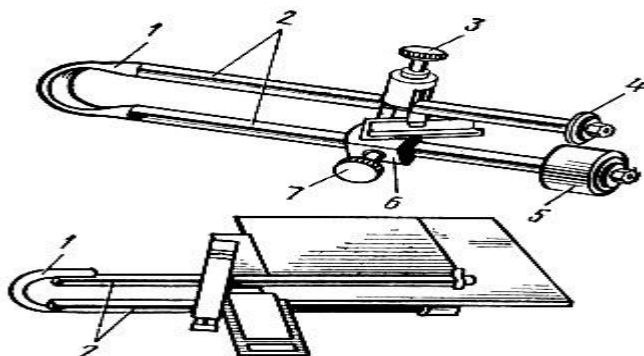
Плиткорез: 1 - стальная пружина, 2 - стальные стержни, 3, 7 - регулировочный и фиксирующий винты, 4 - победитовый резец, 5 - резиновый валик, 6 - движок
